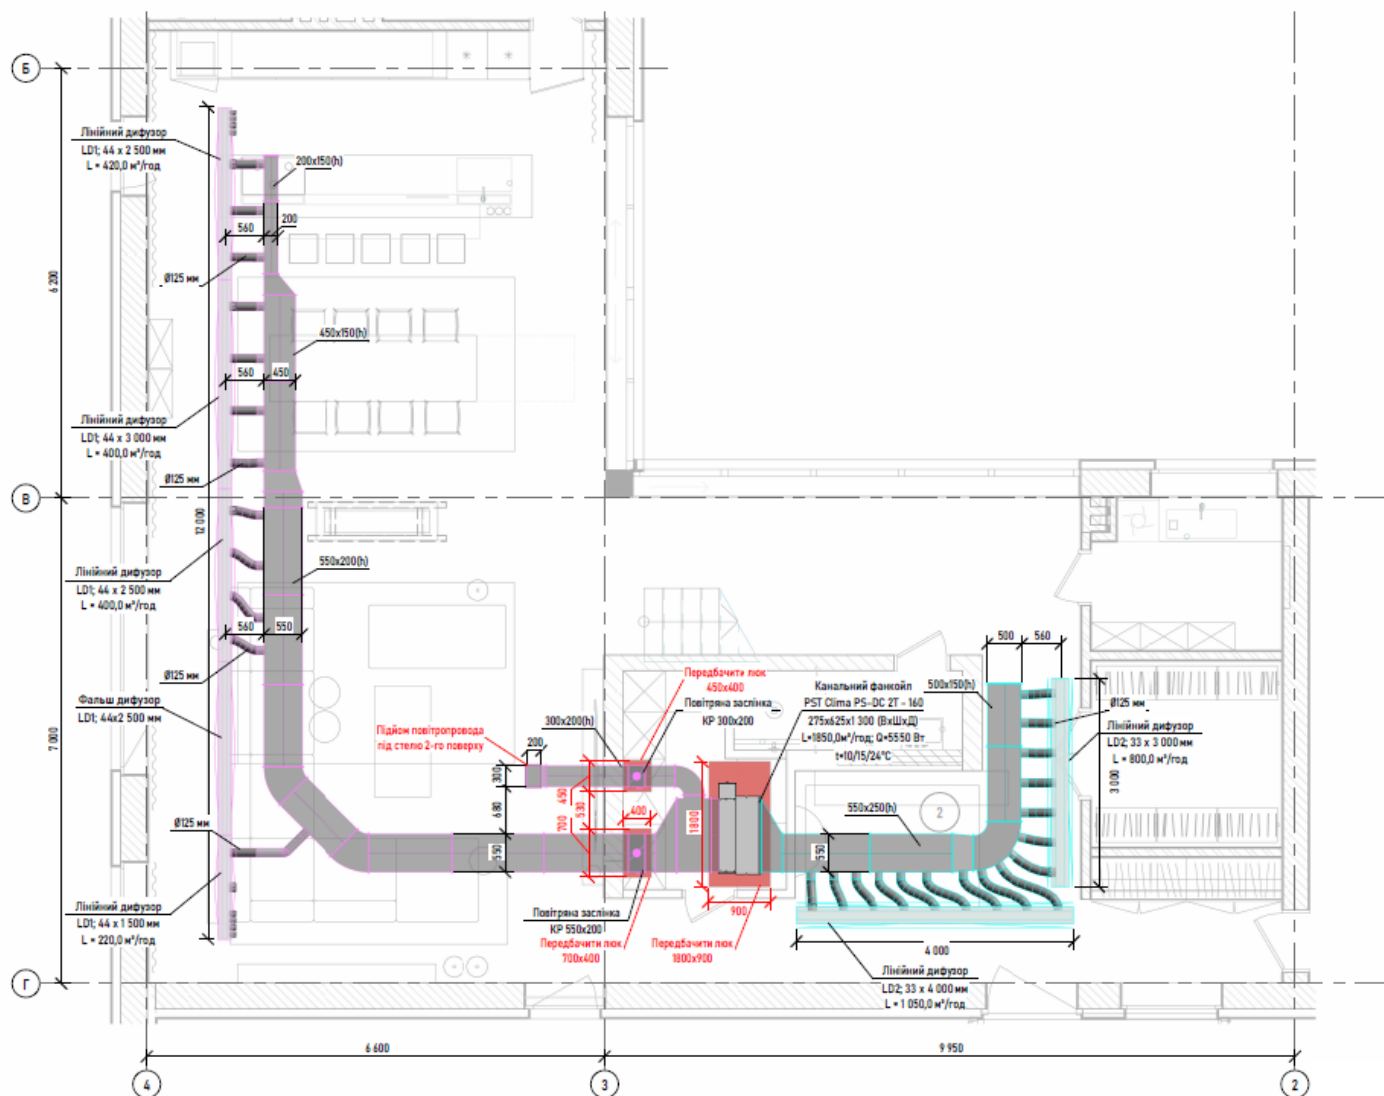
Система охолодження фанкойлами. План 1-го поверху
